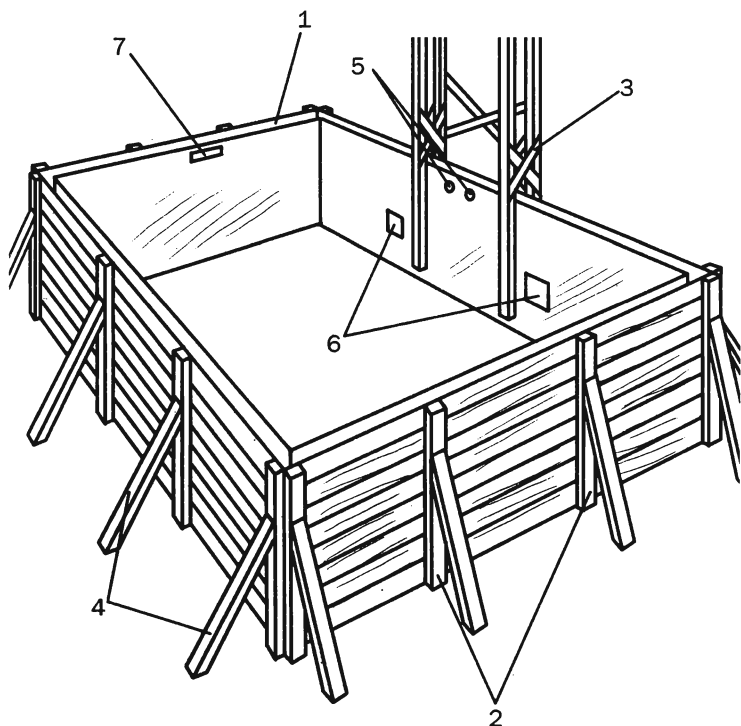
Двусторонняя опалубка для бетонного бассейна:
